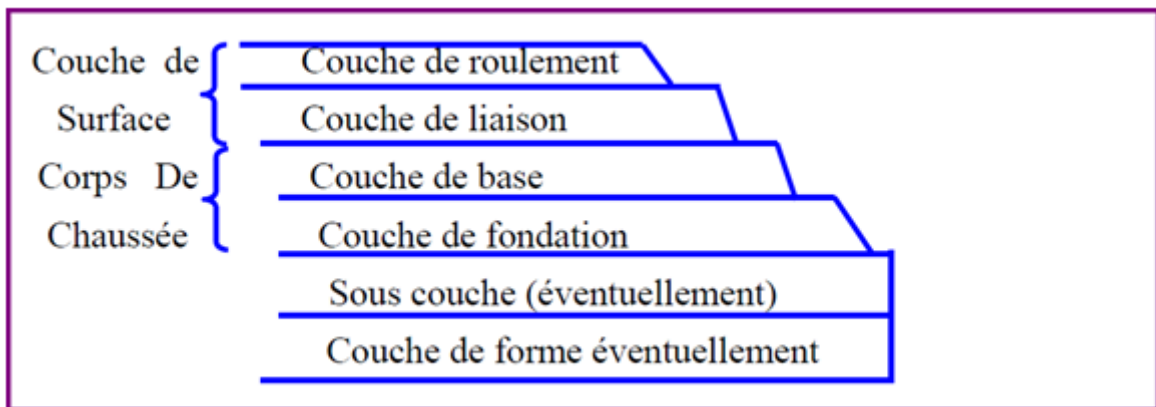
Coupe transversale type d'une chaussée souple[15].
